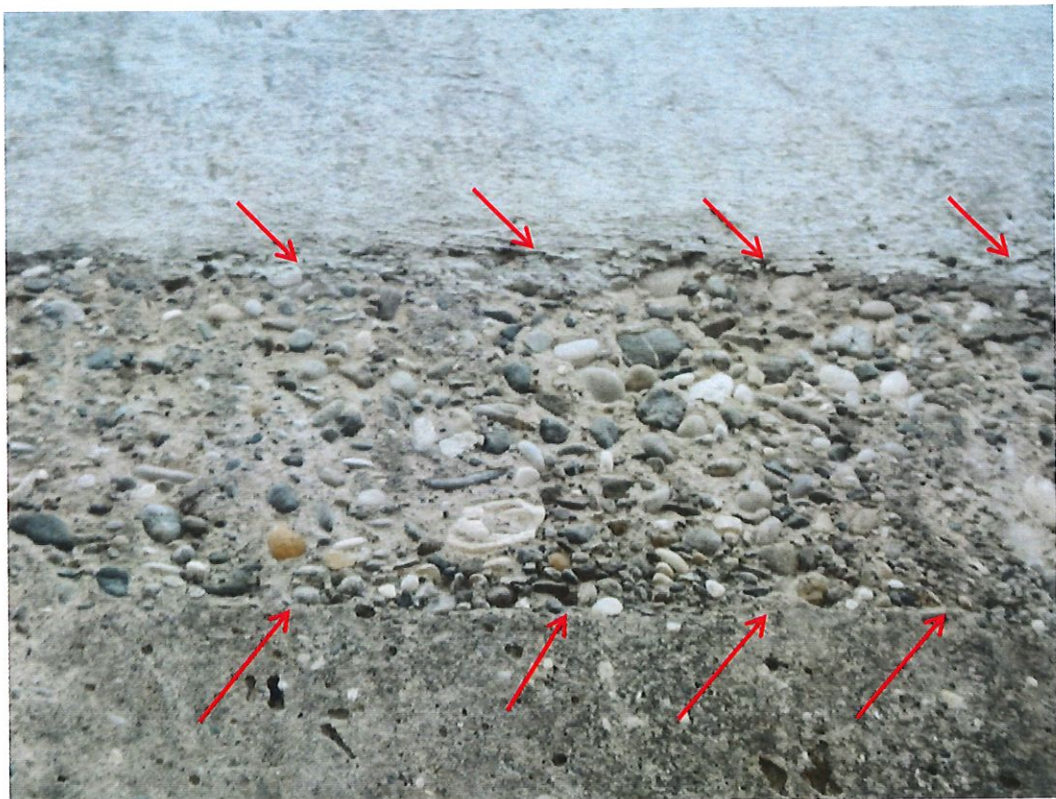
Waschbetonartige Oberflächenstruktur im Bereich der Wasserwechselzone.
